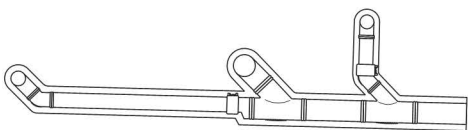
Bei eingemauerten Anschlussleitungen sind kraftschlüssige Verbindungen (Elektromuffen oder Spiegelschweissungen) einzusetzen. Die gesamte Leitung ist mit dem Geberit Dämmschlauch, der Geberit Bandage oder mit Geberit Isol Flex vom Baukörper zu entkoppeln
